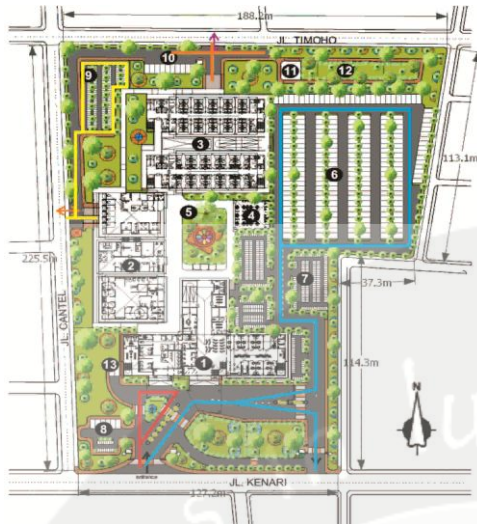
Arah Sirkulasi Horizontal Dalam Bangunan
